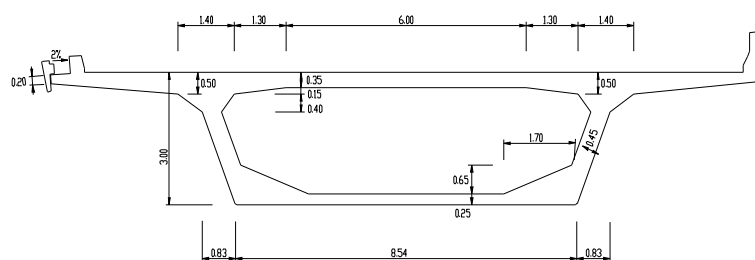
Corte transversal do tabuleiro na zona dos encontros e meio vão entre pilares.
